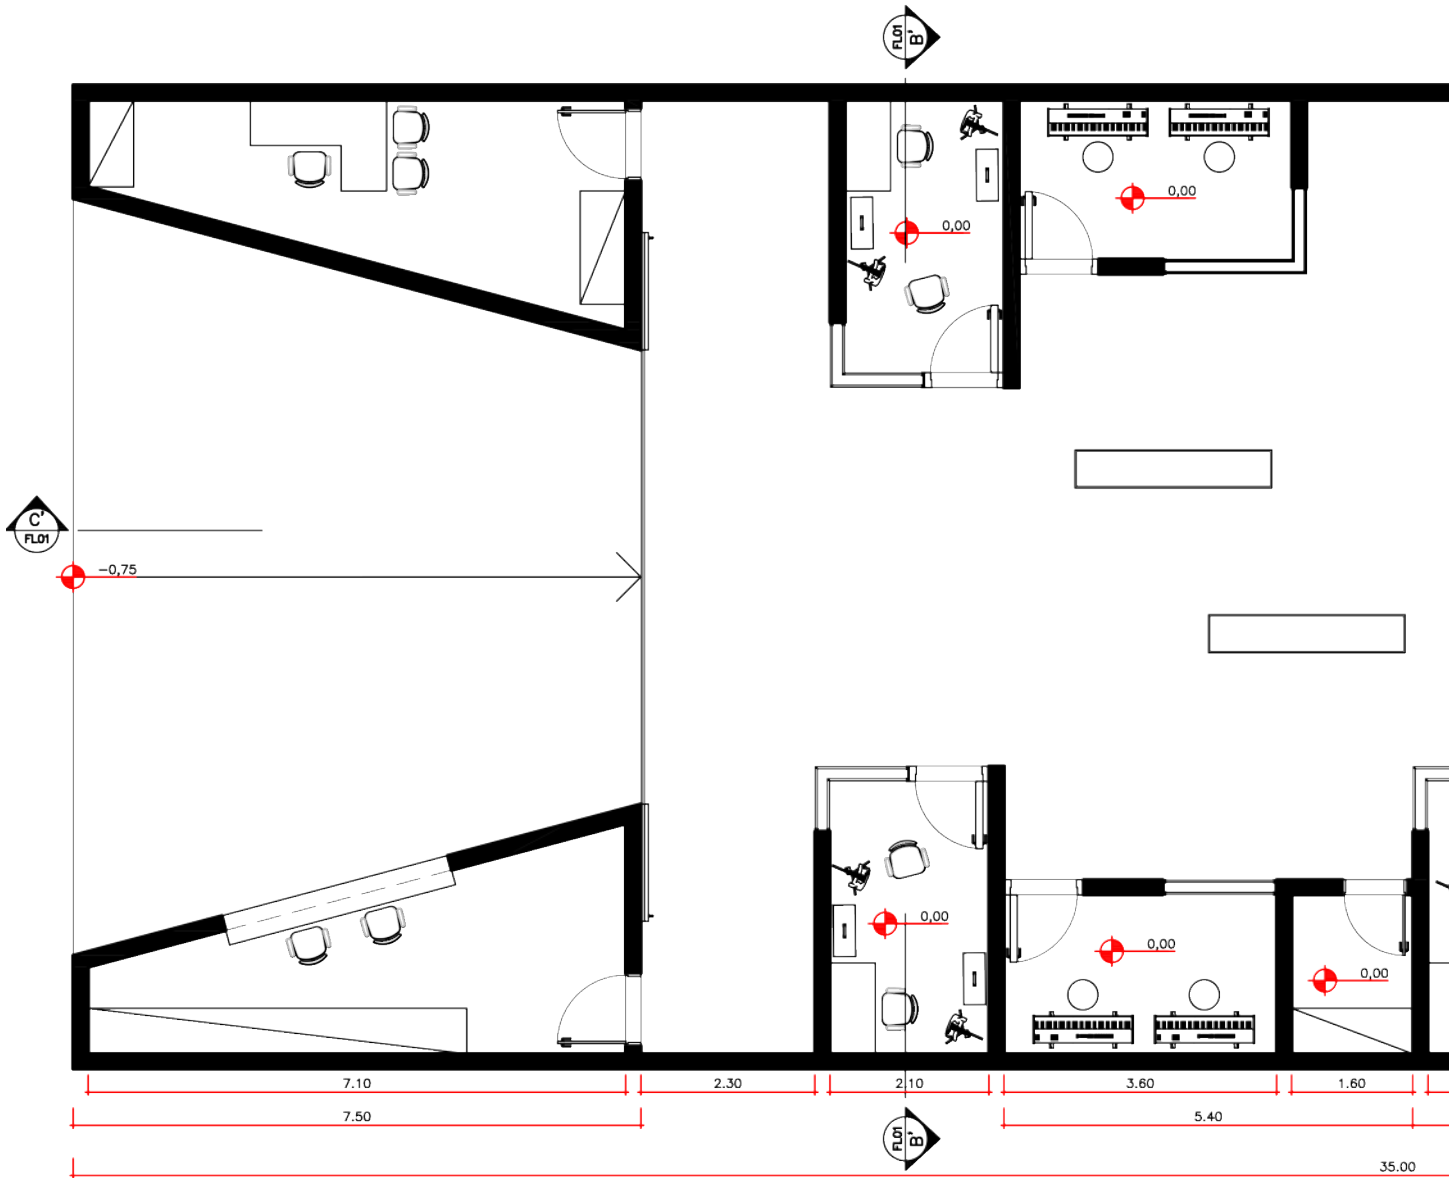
BLOCO SALAS DE AULA - PLANTA -1 - ESC.: 1:200
